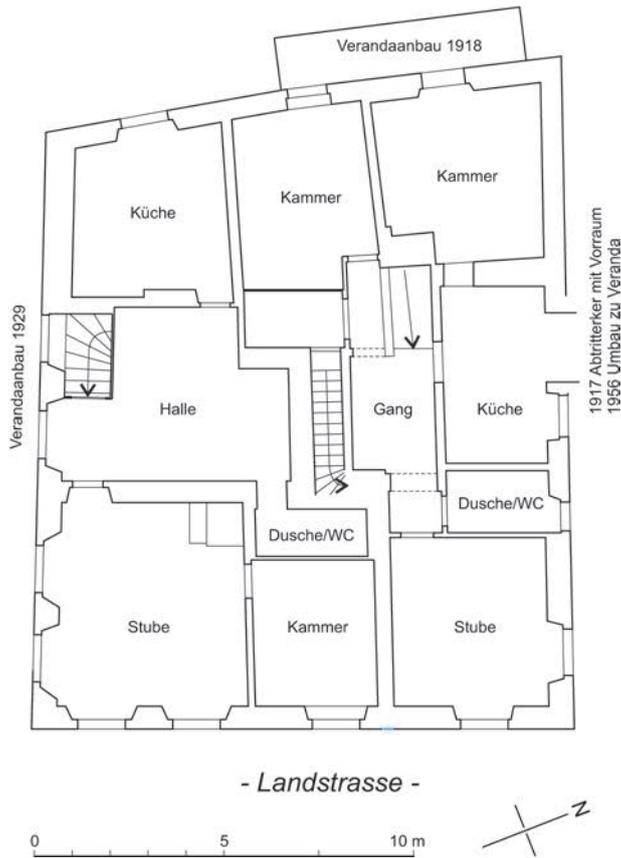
Grundriss Obergeschoss. M. 1:200.
